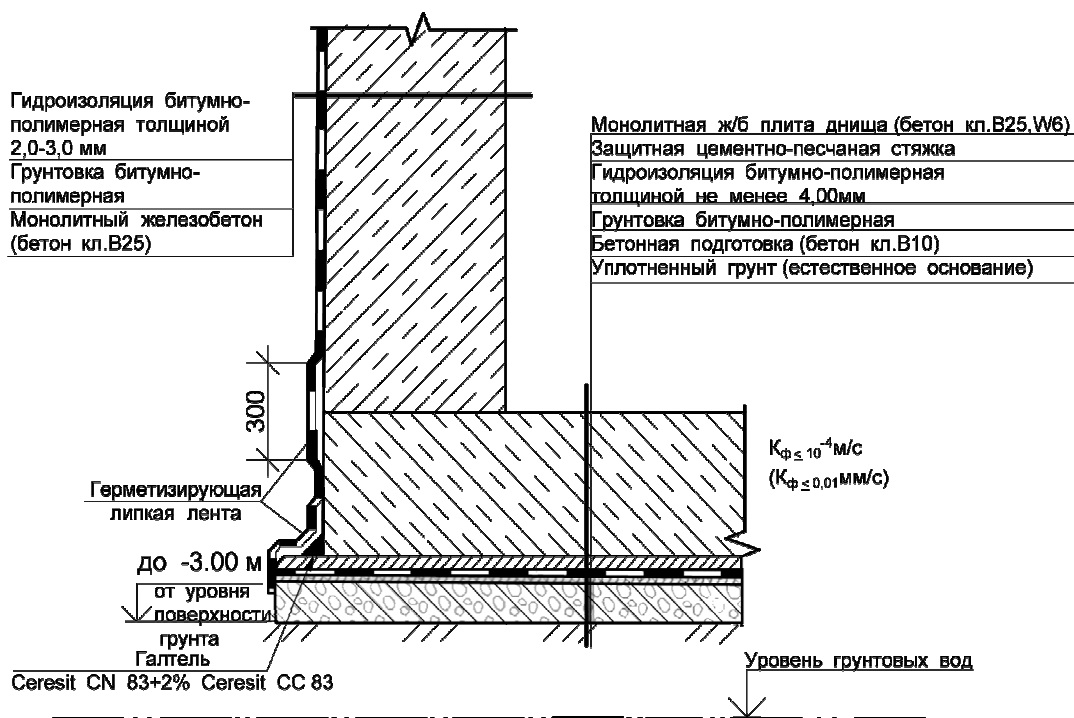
Наружная битумно-полимерная гидроизоляция бетонных плит основания и стен подземных сооружений в условиях воздействия грунтовой влаги
